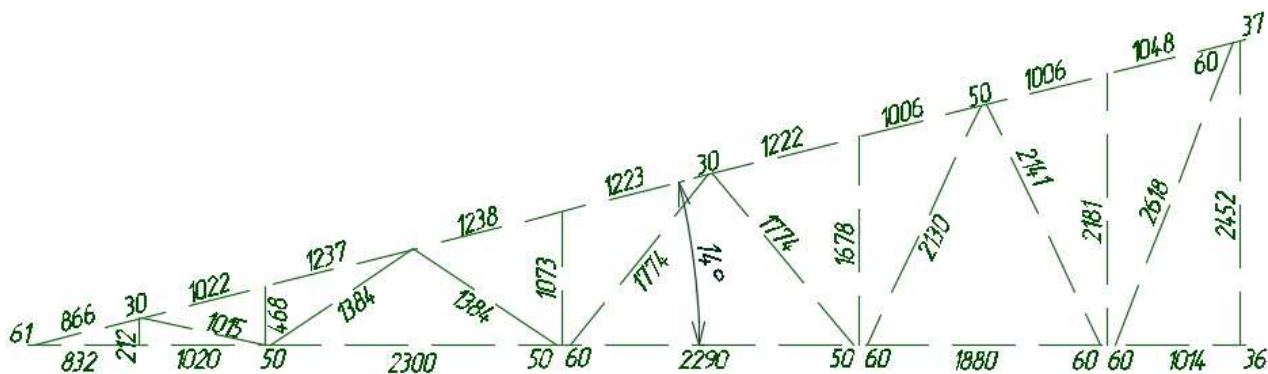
Геометрические размеры фермы Ф1 (полуфермы)
